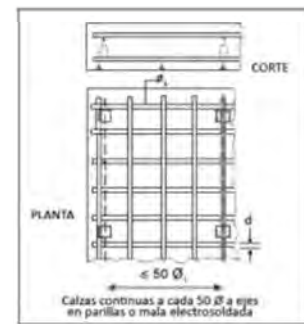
CALZAS CONTINUAS EN EMPARRILLADO SUPERIOR DE LOSA
